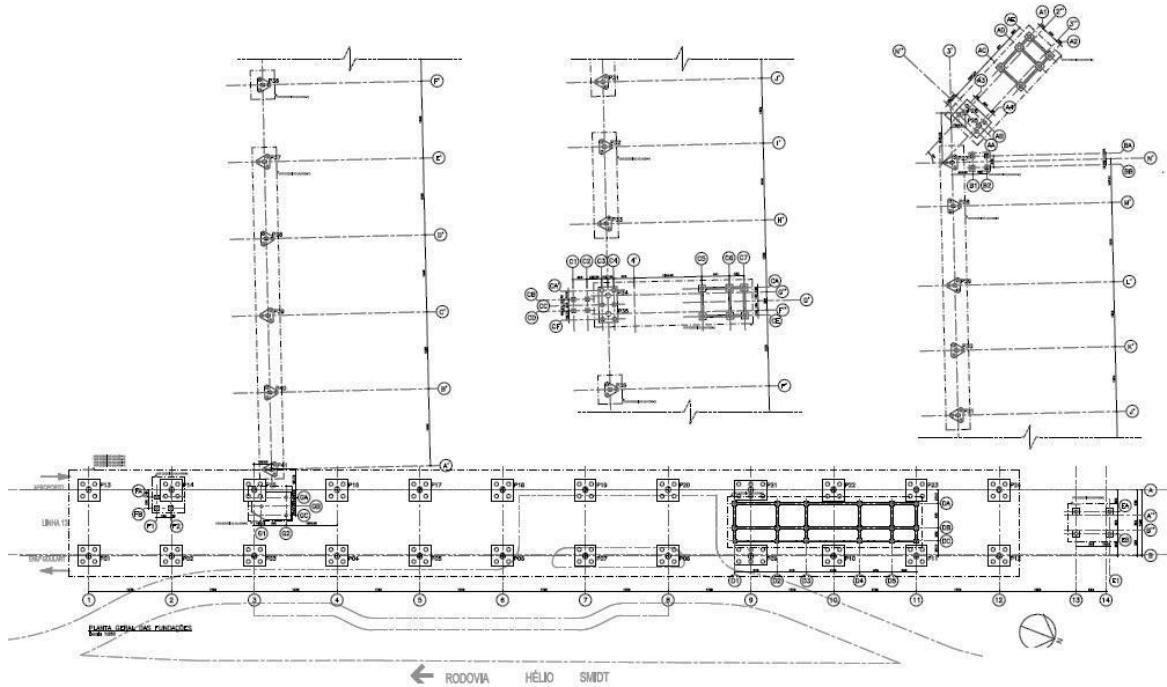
Planta de Fundações - Estação Guarulhos CECAP (CPTM, 2013).
